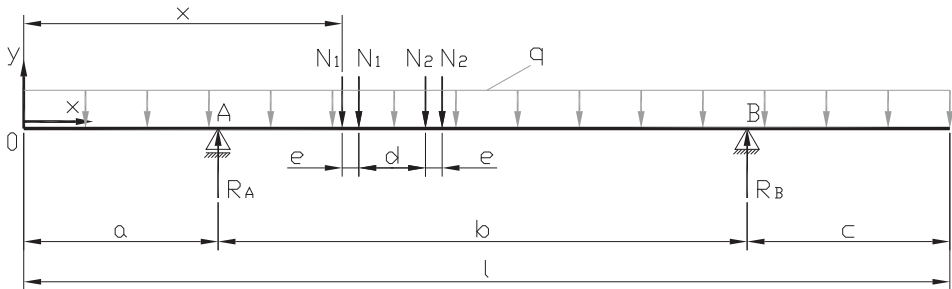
Konstrukcja przęsła (przekrój podłużny)
